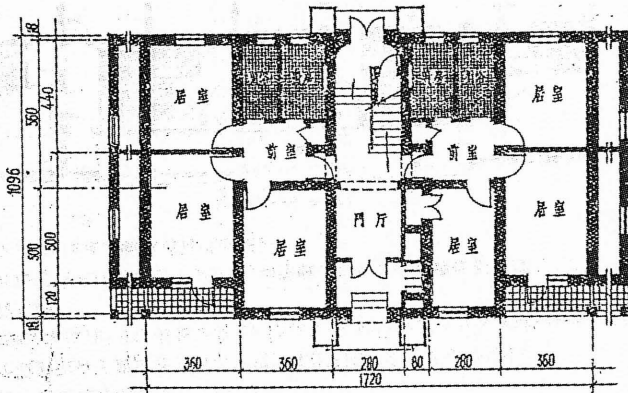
地壇住宅区乙型実験住宅 二一单元平面图
